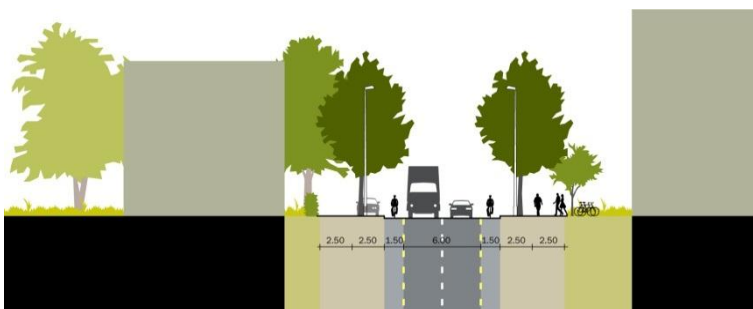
Regelquerschnitt Zentralstrasse: Dichte Baumallee (grosskronige Bäume) kombiniert mit Längsparkierung, stark durchgrünte private Vorbereiche
